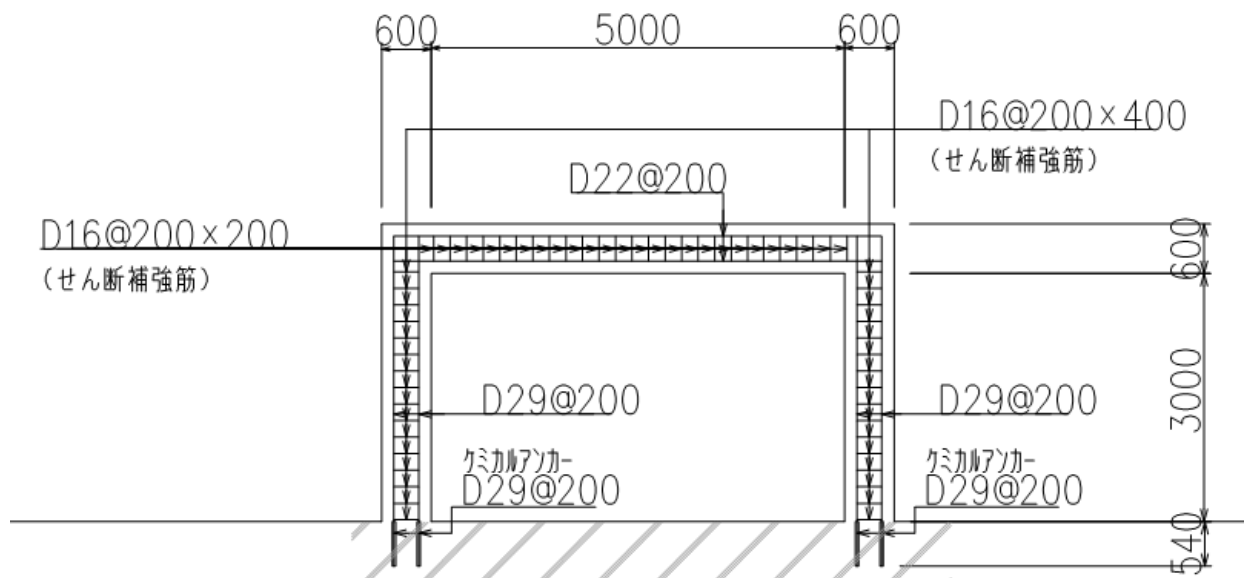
ポンベ庫 概略配筋図 (B-B 断面)
